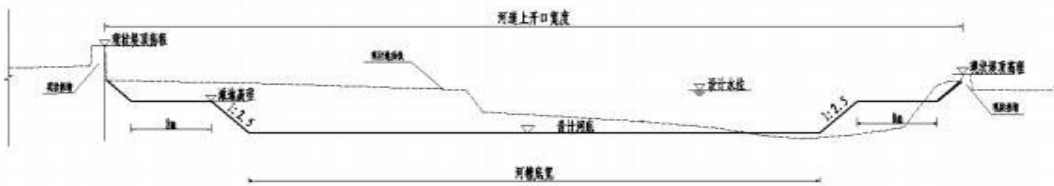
现状墙式护岸段（桩号 65+487）横断面示意图
